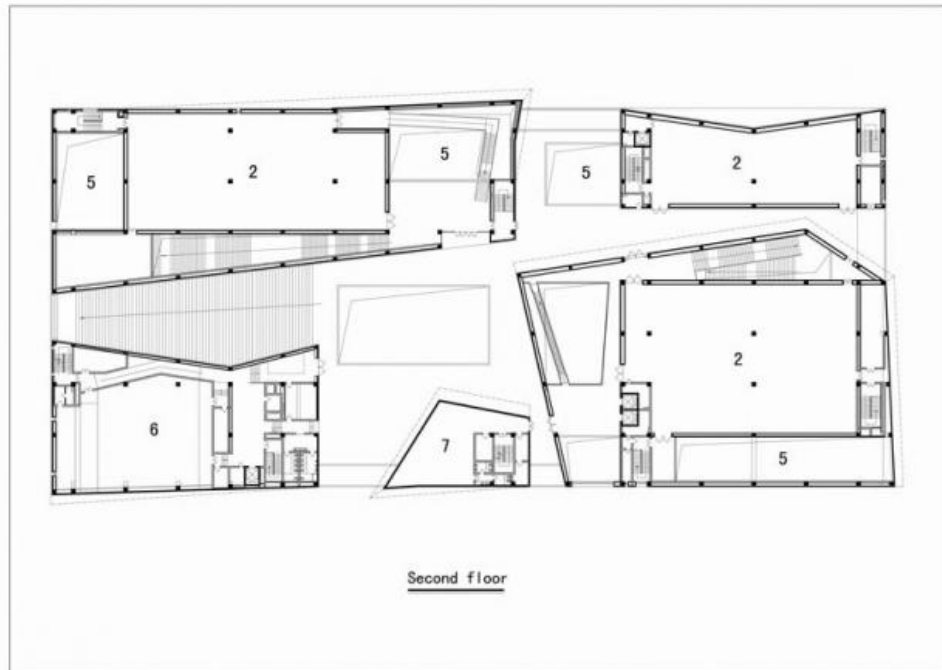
Site Plan Ningbo Historic Museum
